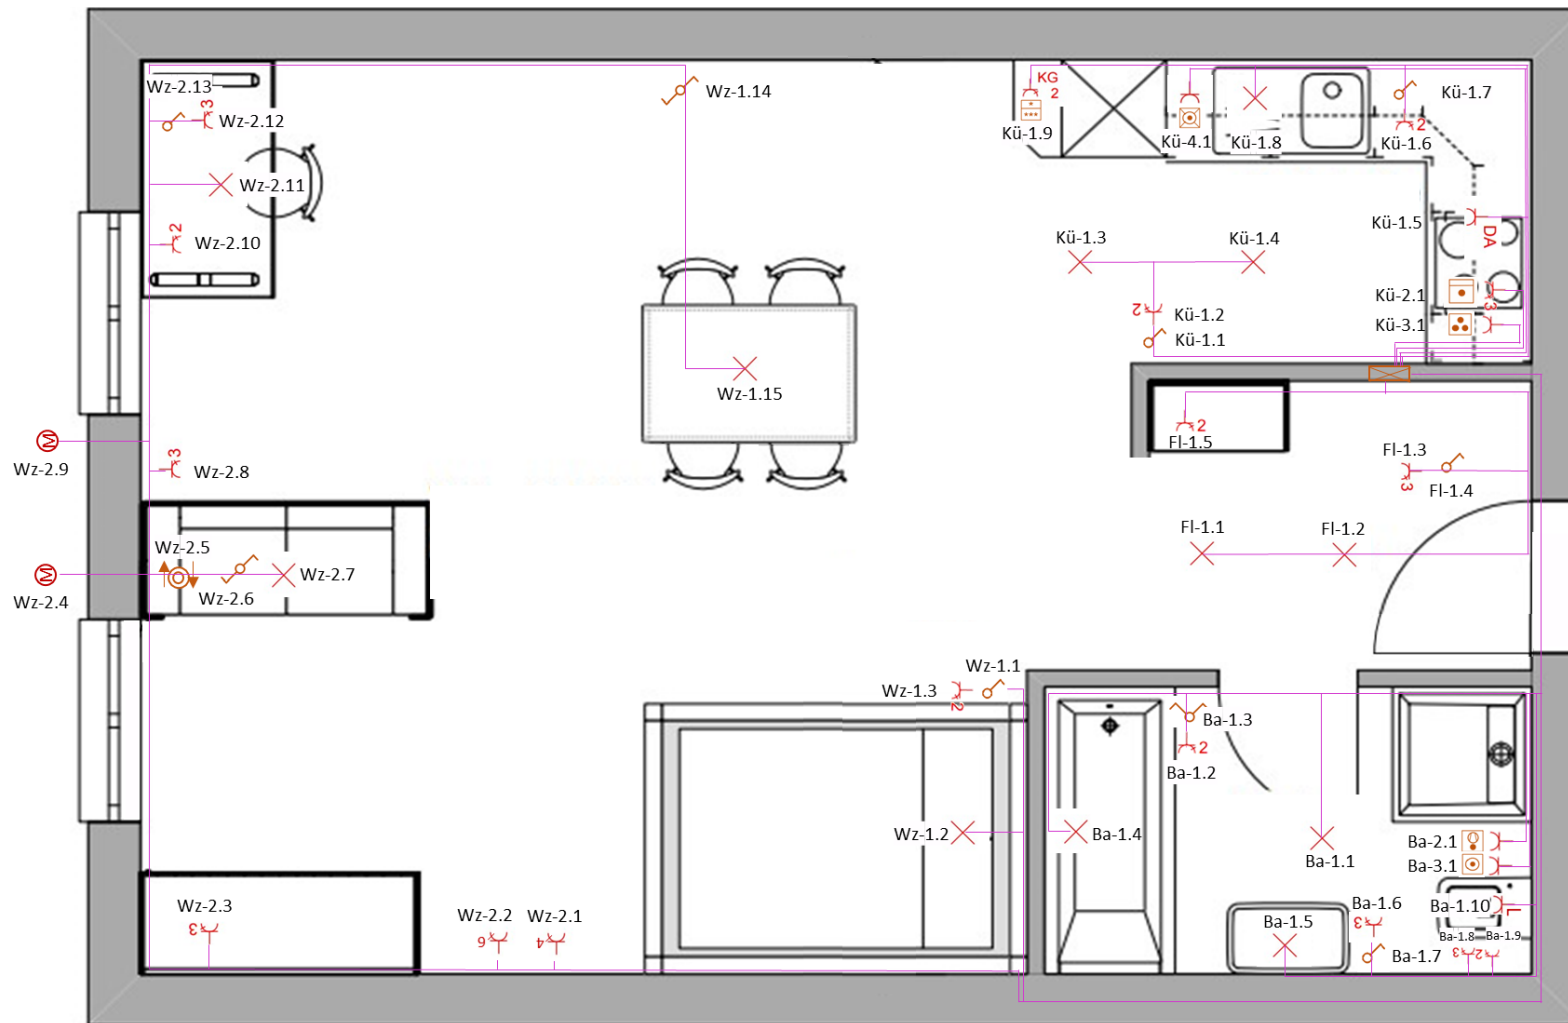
Grundrissplanung, Einzimmerwohnung- konventionelle Verkabelung
